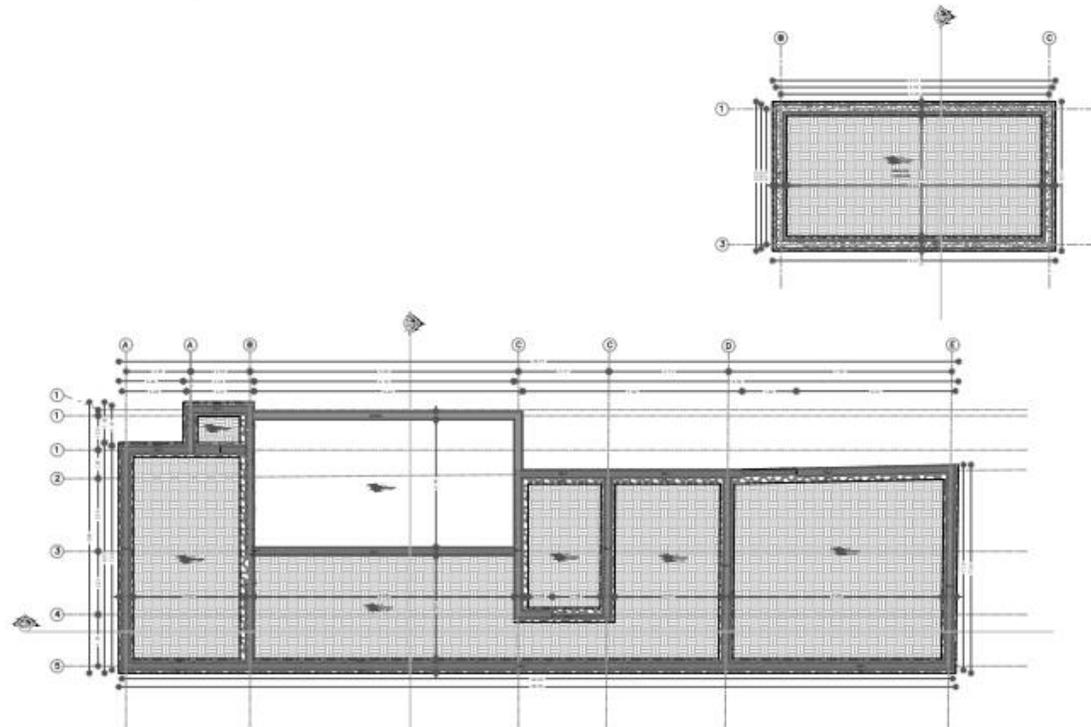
PLANTA DE CIMENTACION CARIONGO. EXITENTE EN LA ACTUALIDAD
